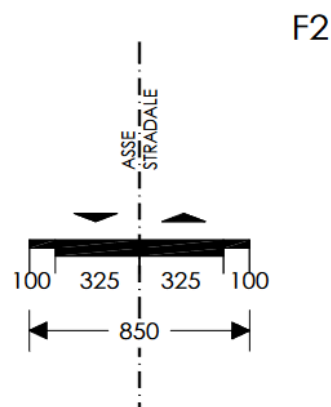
Sezione tipo F2 – Locale extraurbana
